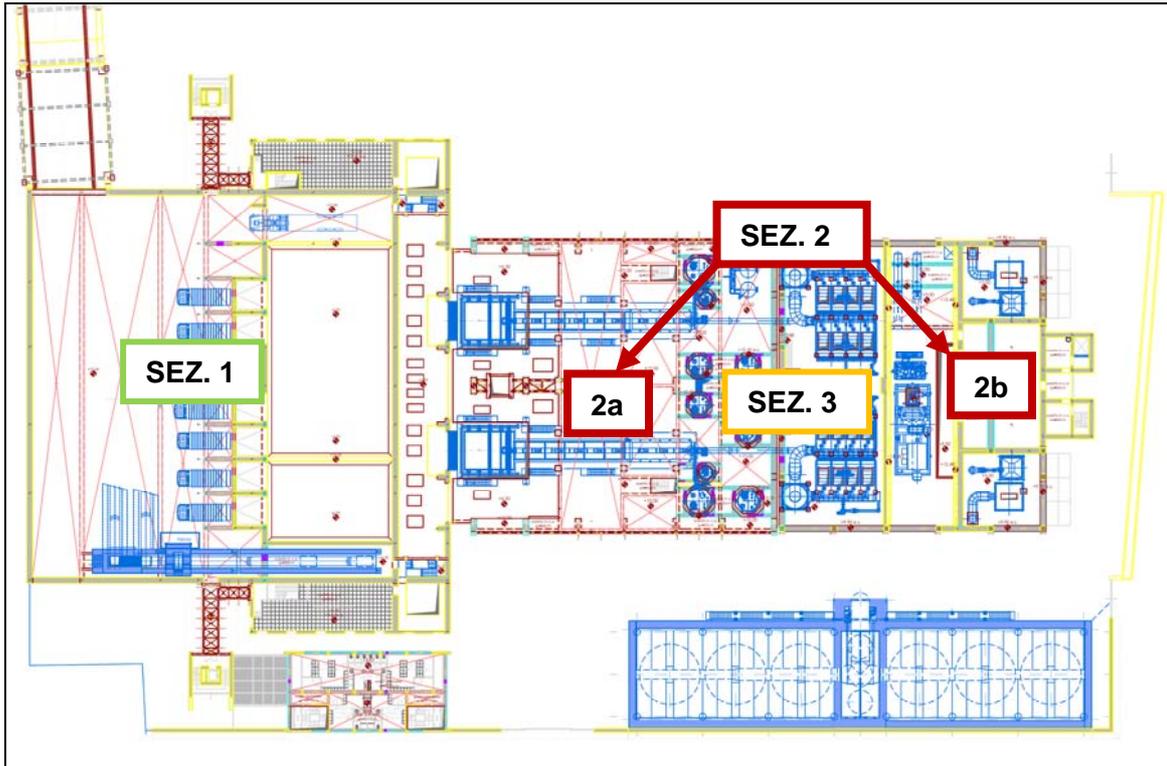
Layout impianto con indicazione delle principali sezioni impiantistiche
